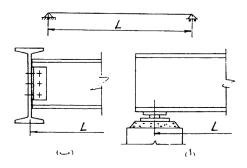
1) مفاطع مبرشمة مبية (Riveted Built- up Sections)
